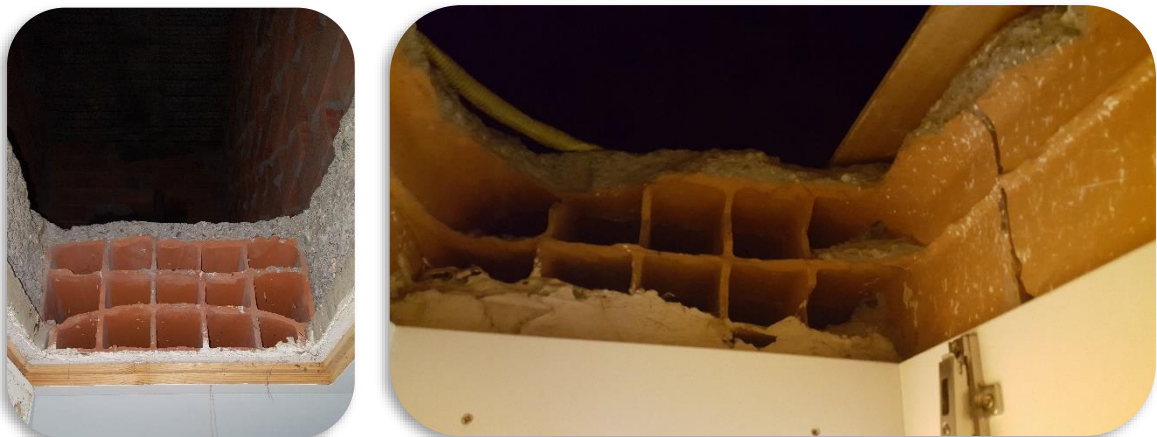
Vista del forjado bajo cubierta de 2 centros, en la trampilla de acceso.
